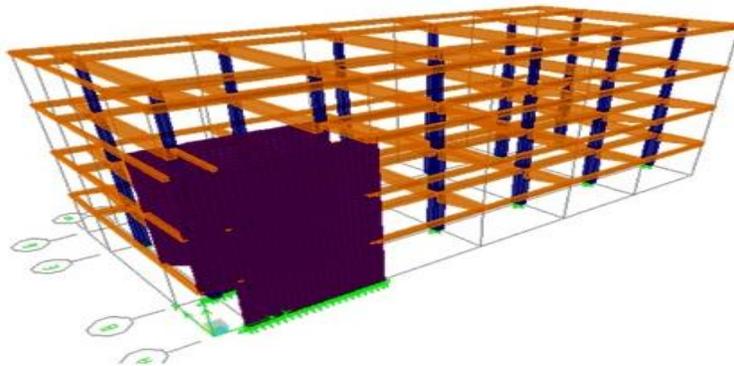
Vista en 3D del Módulo “A” de la Edificación en el Modlo1 (M1).
